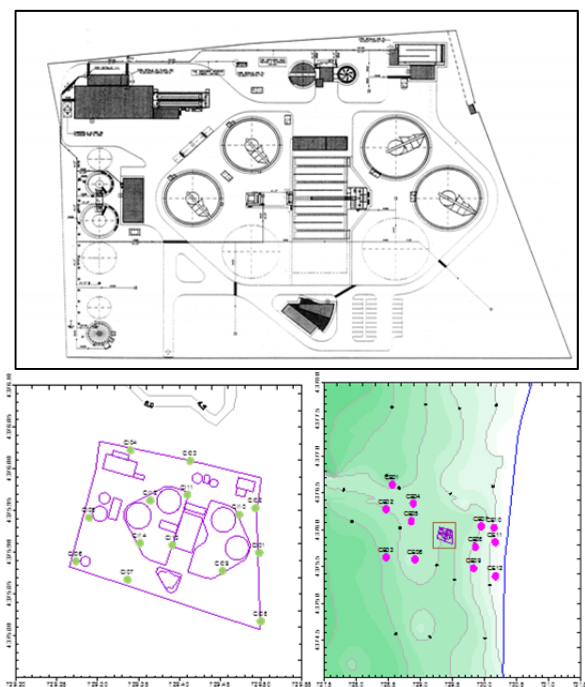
Planta de la EDAR de la Conca de Carraixet (arriba; fuente: www.epsar.gva.es). Red de muestreo interior (figura abajo izquierda; fuente: Aplicación DIMEDAR) y red de distribución exterior (figura abajo derecha; fuente: SURFER)
